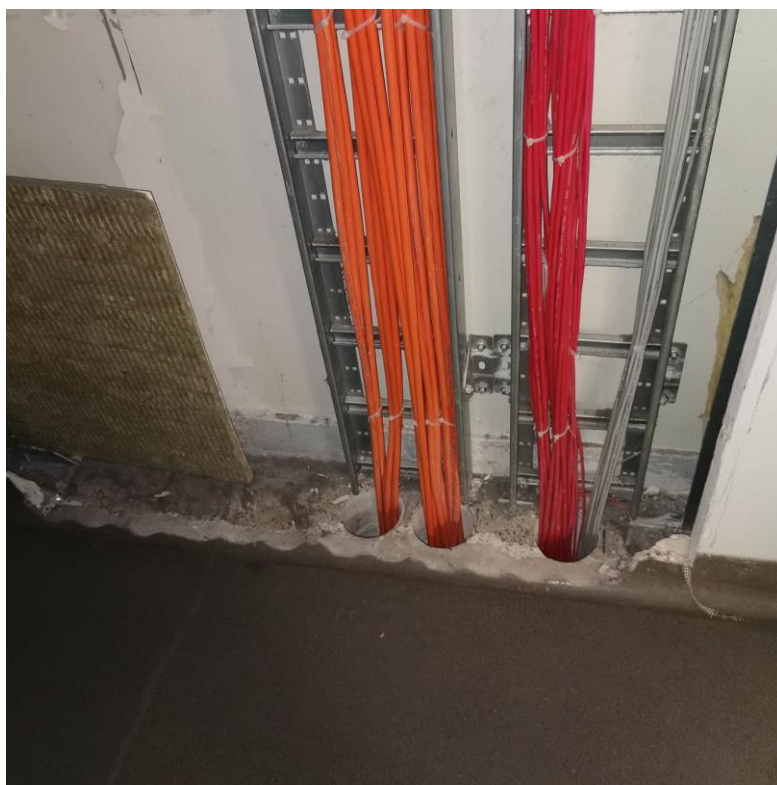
Brak zamontowanej stolarki drzwiowej – elementu ochrony przeciwpożarowej. BUD.B.
